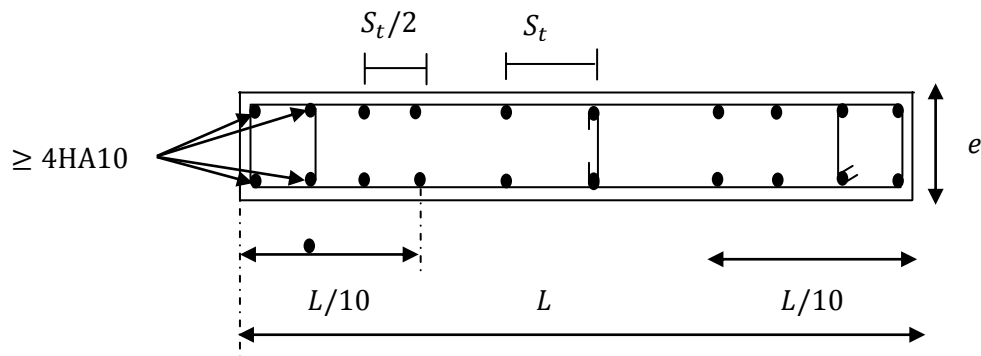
Disposition des armatures verticales dans les voiles.
